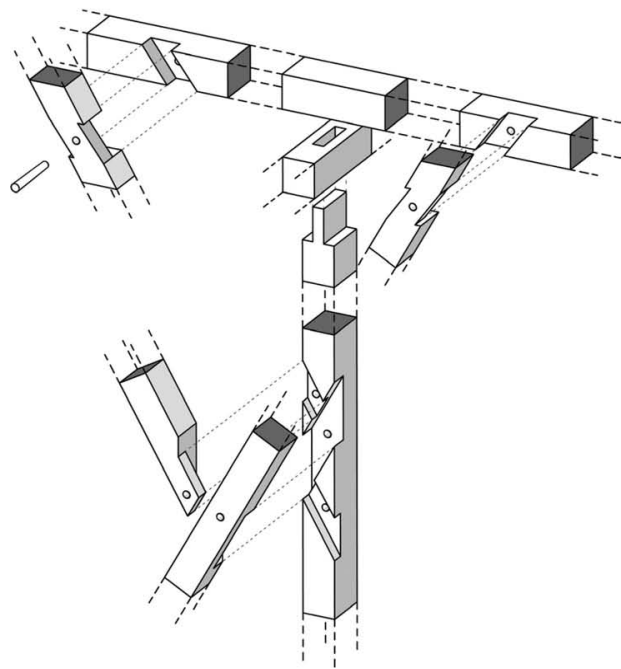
e 18: Detalhe das ensambladuras executadas em uma construção gótica do séc. XVIII.
